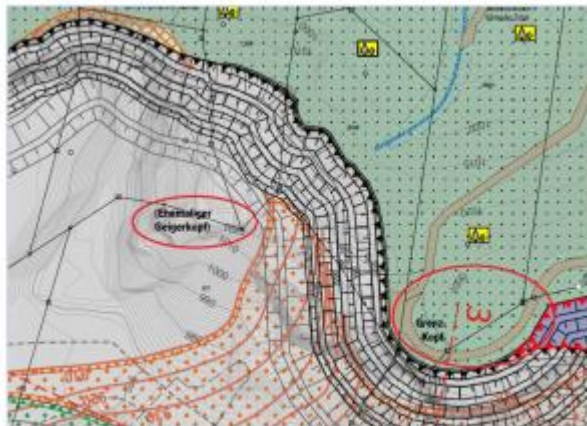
Abbauplan 2020 - Quelle: 1. Änderung Bebauungsplan 2020
